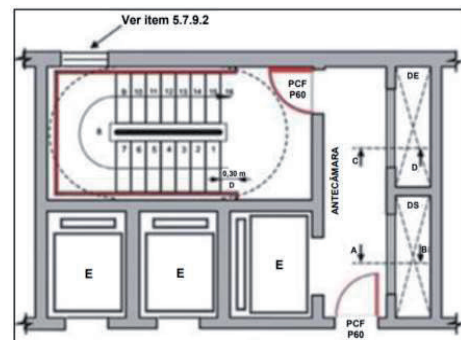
Escada Enclausurada à Prova de Fumaça com elevador de Emergência (a posição deste é somente exemplificativa) na antecâmara.
